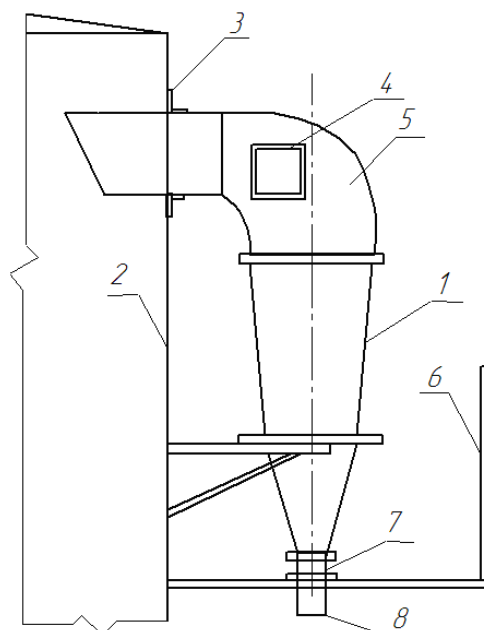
Установка ГВПС-2000 на резервуаре:
